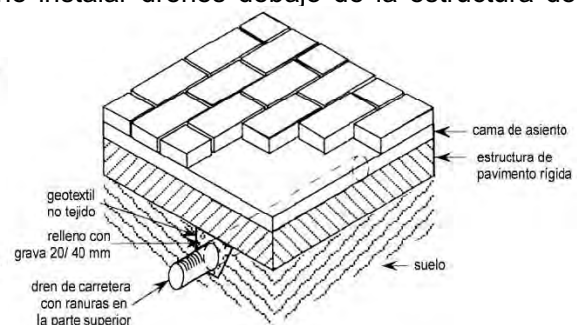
ZONA CENTRAL Y ZONAS INTEREDIAS – Drenaje del fondo de la capa de conformación con dren de PVC
